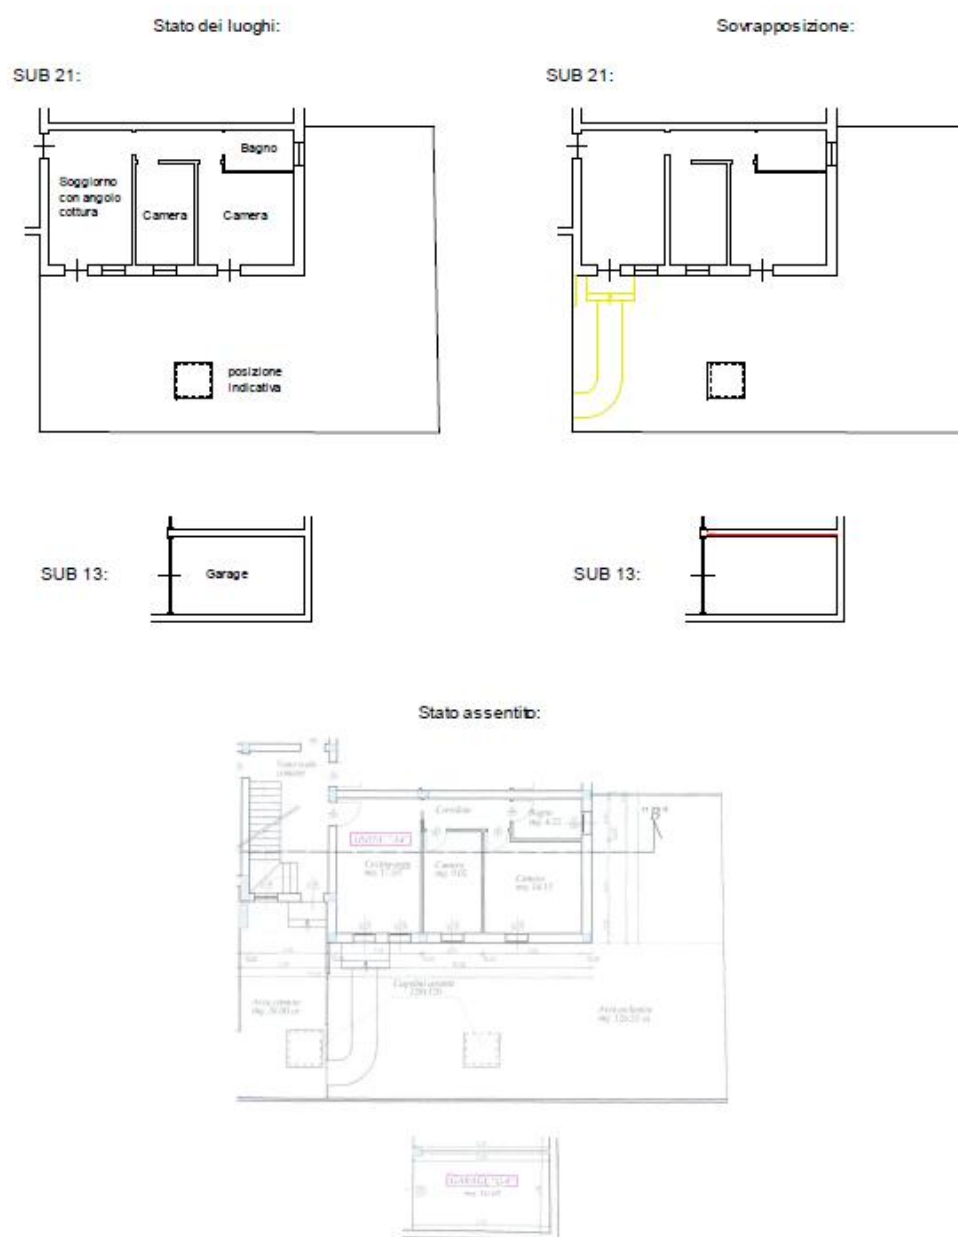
Comparazione schema planimetrico rilevato – stato approvato DIA 104/2007- la sovrapposizione è indicativa di massima. All 3.3
